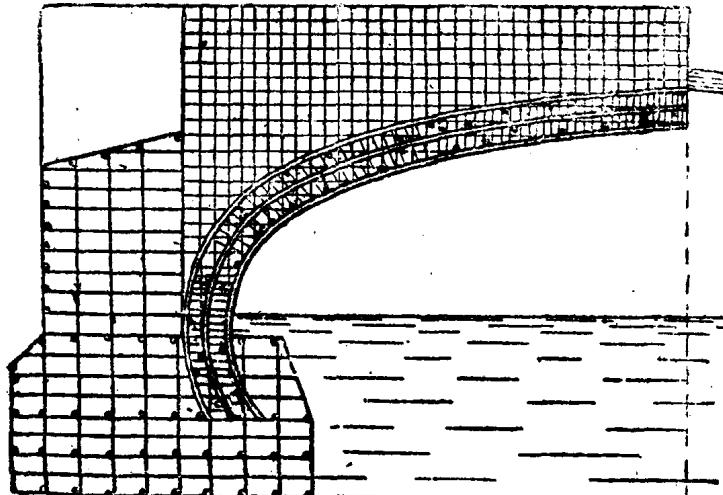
蒙約体系鋼筋混凝土橋梁的配筋
